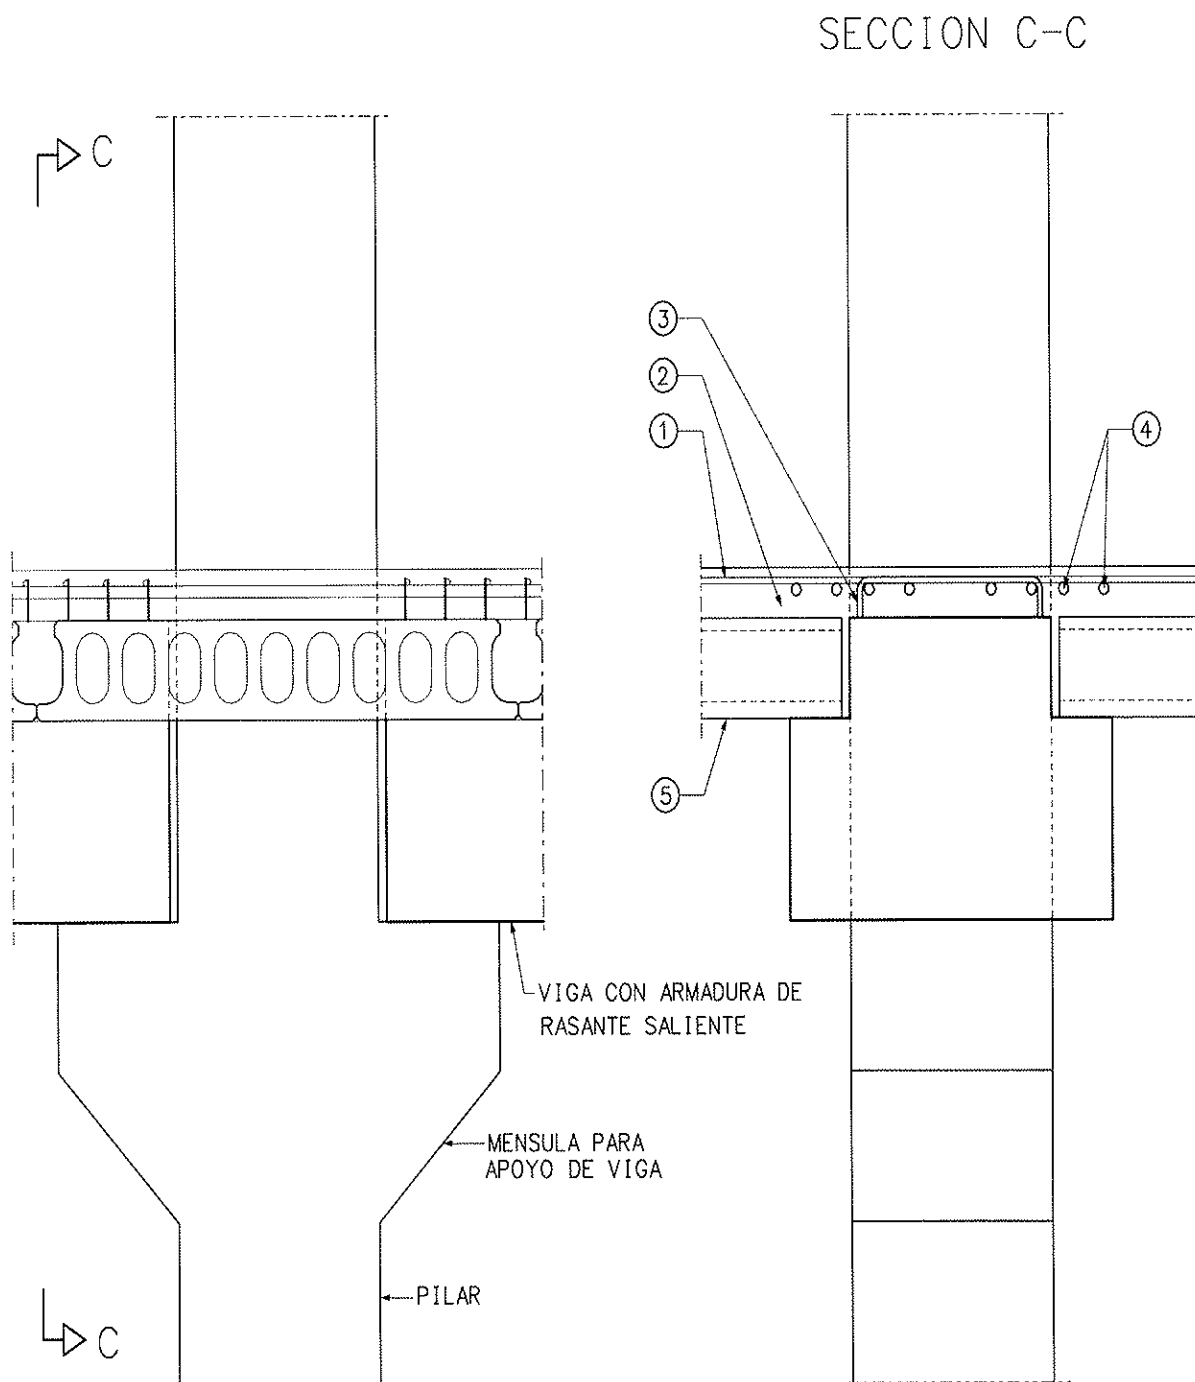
Nudo pilar-viga con apoyo de vigas sobre ménsulas y continuidad parcial de vigas.
